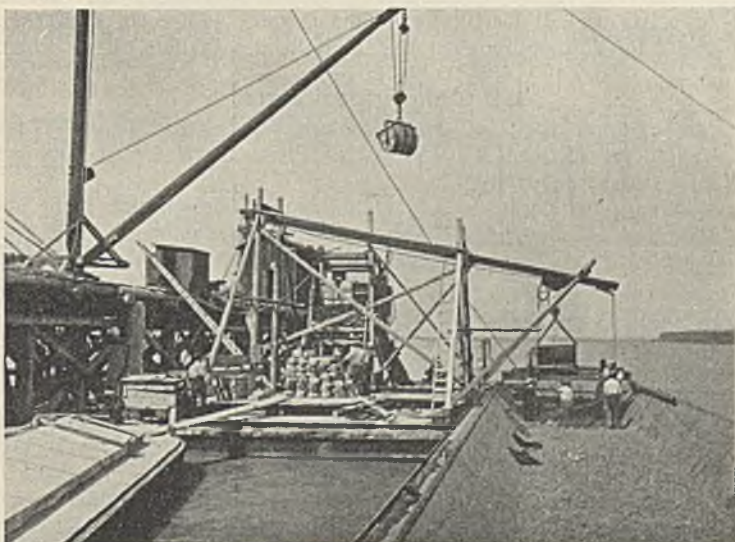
Fertigbetonierung eines Pfeilers mit Derrick und behelfmäßiger Betonmischanlage.
